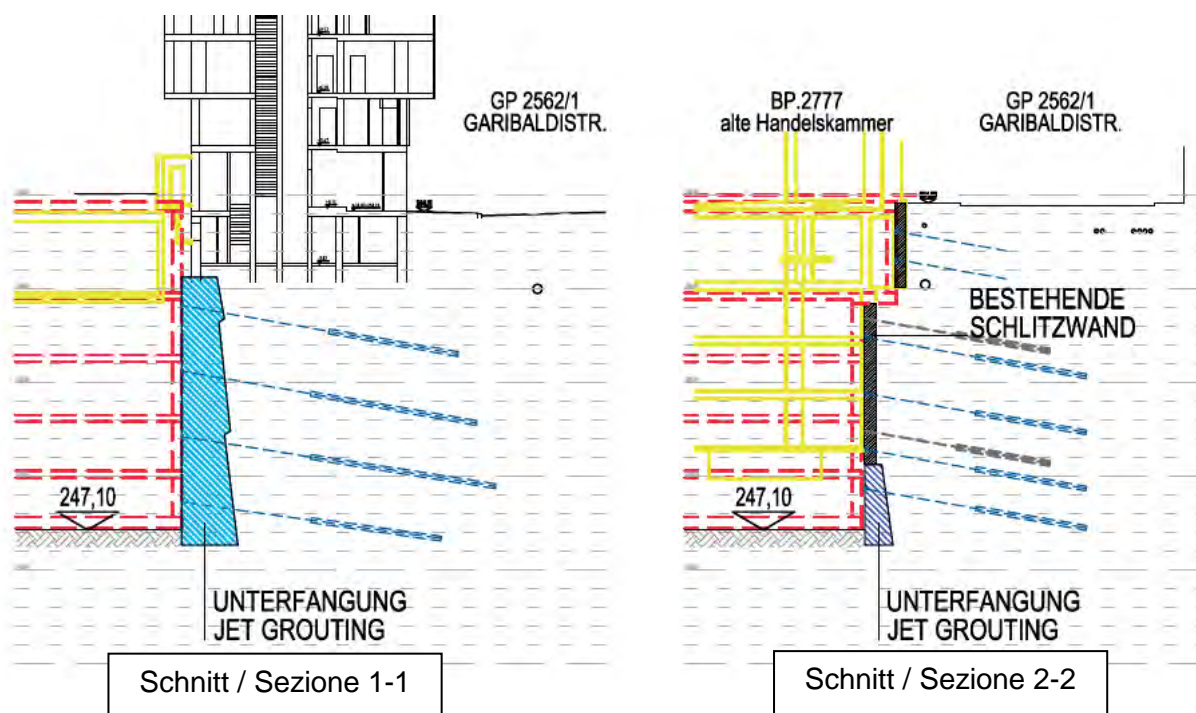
Sezioni tipo della sottomurazione di scavi jet grouting
